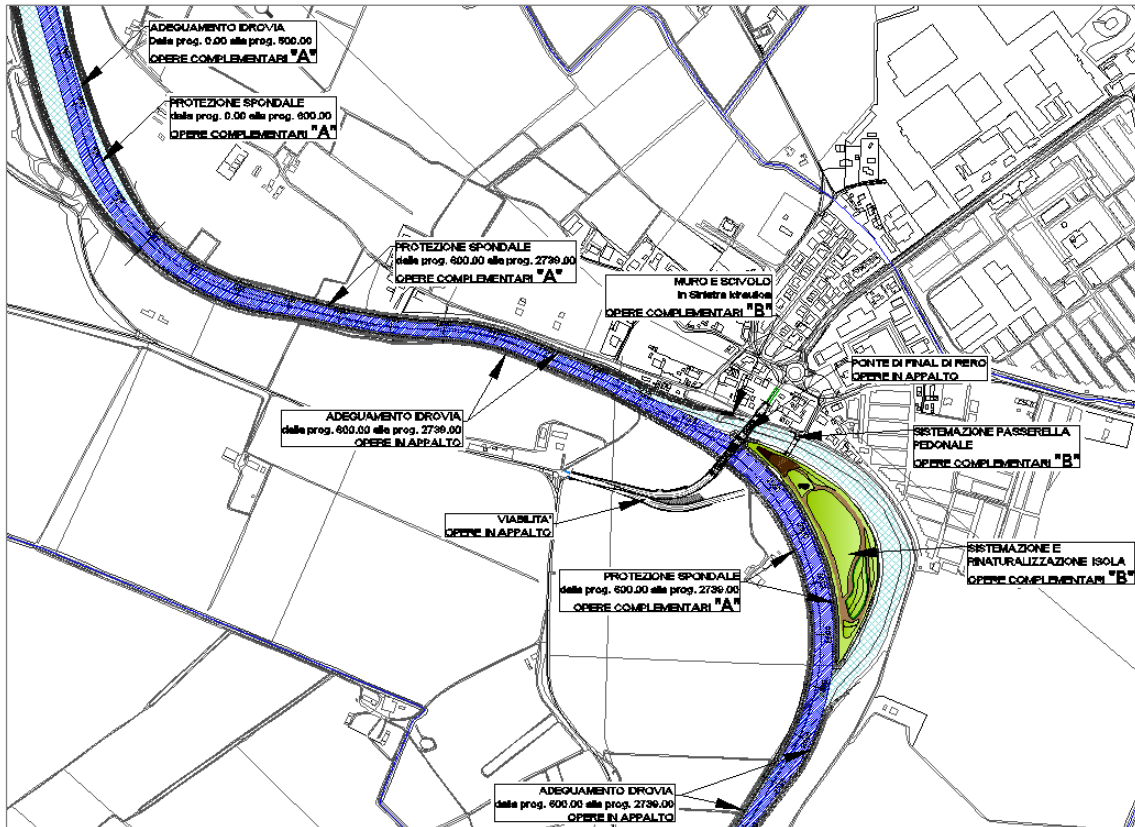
Rappresentazione planimetrica dell'area di intervento con indicazione delle parti d'opera appartenenti ai vari stralci di lavoro previsti
